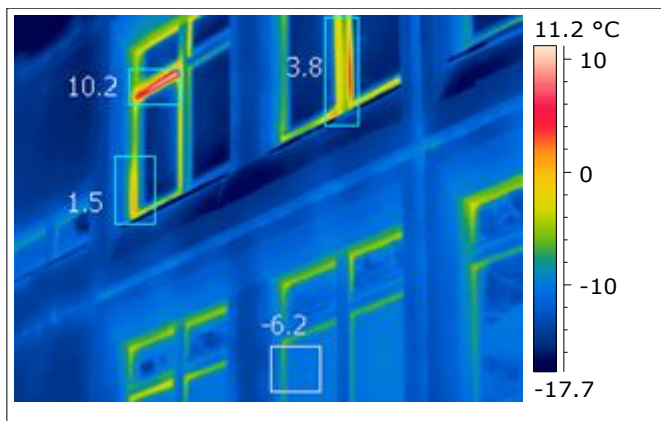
Локальное нарушение монтажа оконных блоков, вызывающее повышенные теплопотери
